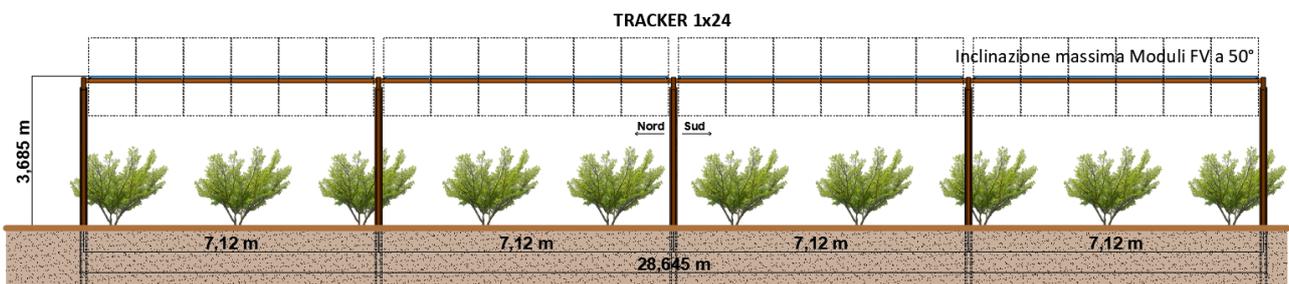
Particolare disposizione moduli su tracker in prospettiva (configurazione 1x24)
